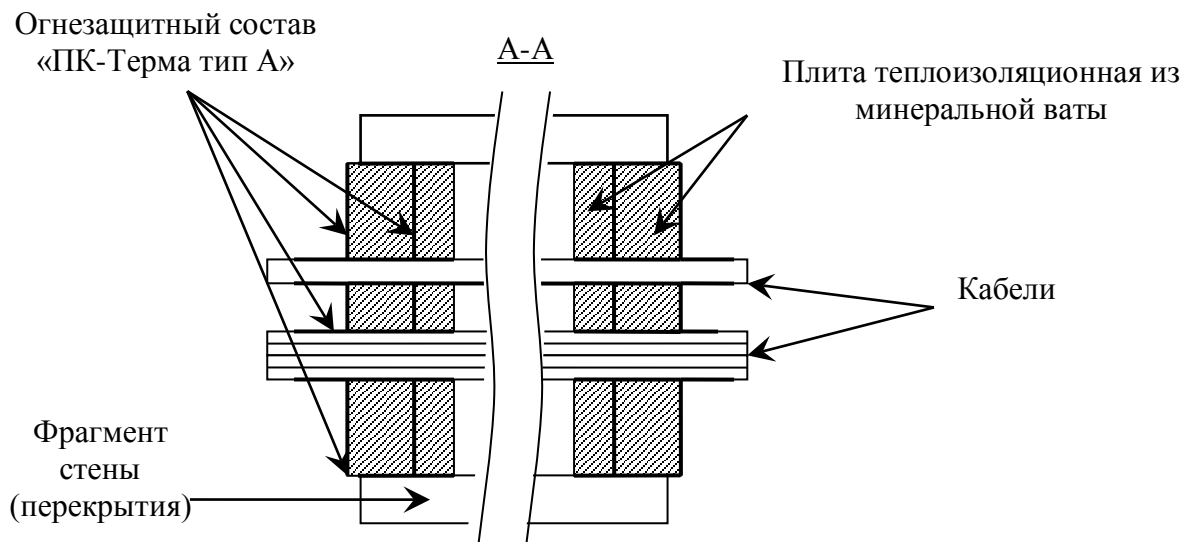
Схема монтажа кабельной проходки «ПК-ТЕРМА тип А»
